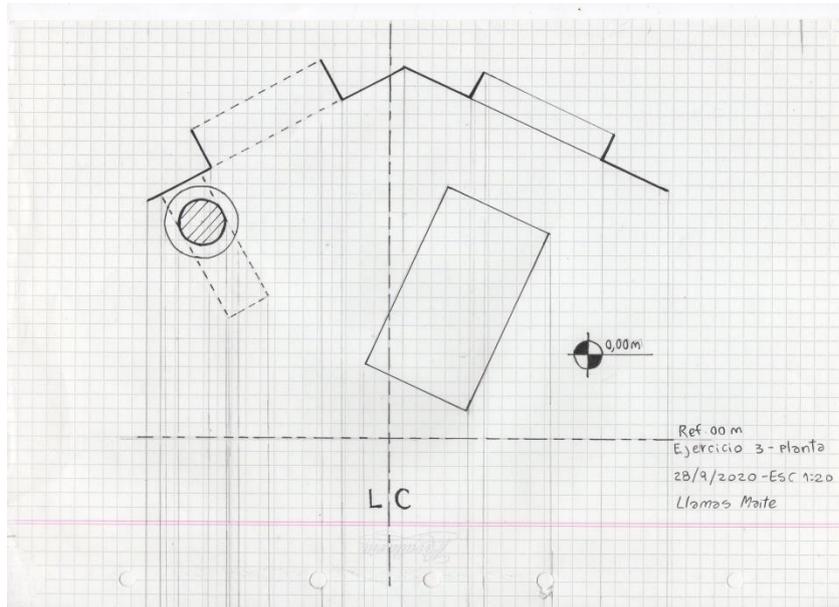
Trabajo de vista en planta - Estudiante Maite Llamas
